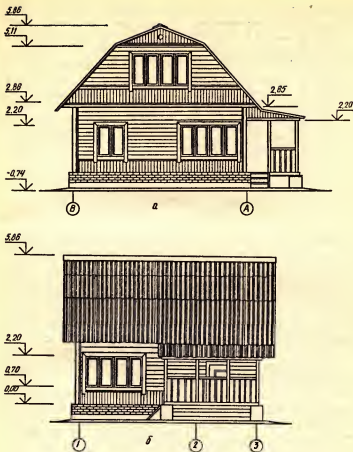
Главный (а) и боковой (б) фасады садового дома с мансардой
